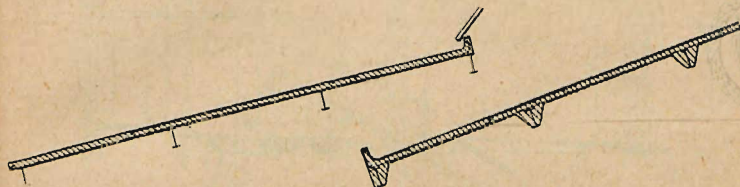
Dach płytowy; płyta na płatwiach. Fig. 627. Dach płytowy; płatwie obetonowane.
